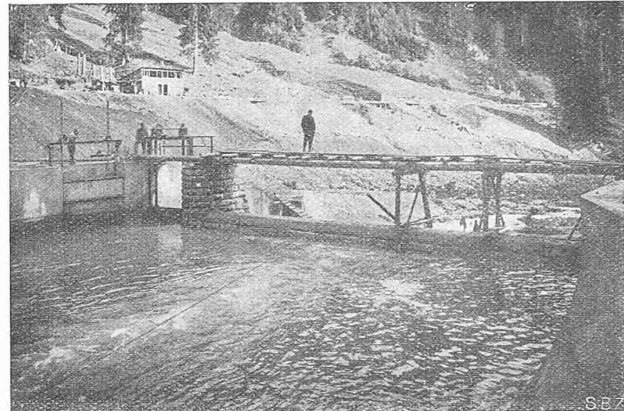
Wehr mit Grundablass und Einlauf (21. Sept. 1921).
